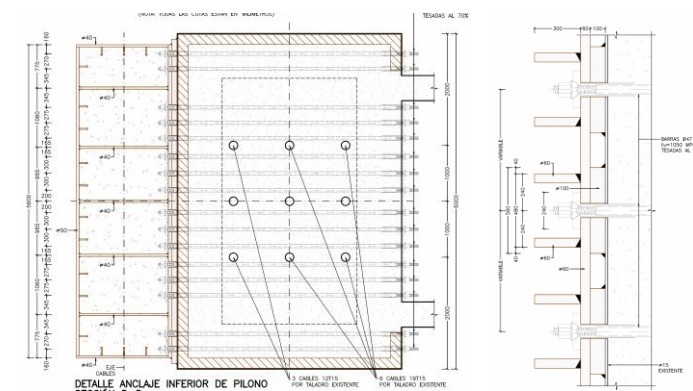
Detalle de conexión recrecido pilono-travesaño inferior.
